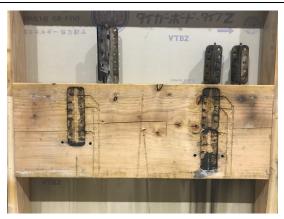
試験体 1-2 耐火構造壁内の梁(金物取り外し後)
